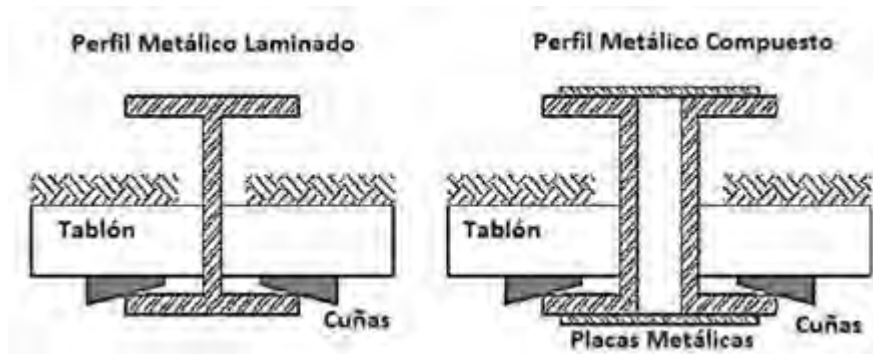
Perfiles de acero utilizados en el muro Berlinés. (Alarcón, 2011)
